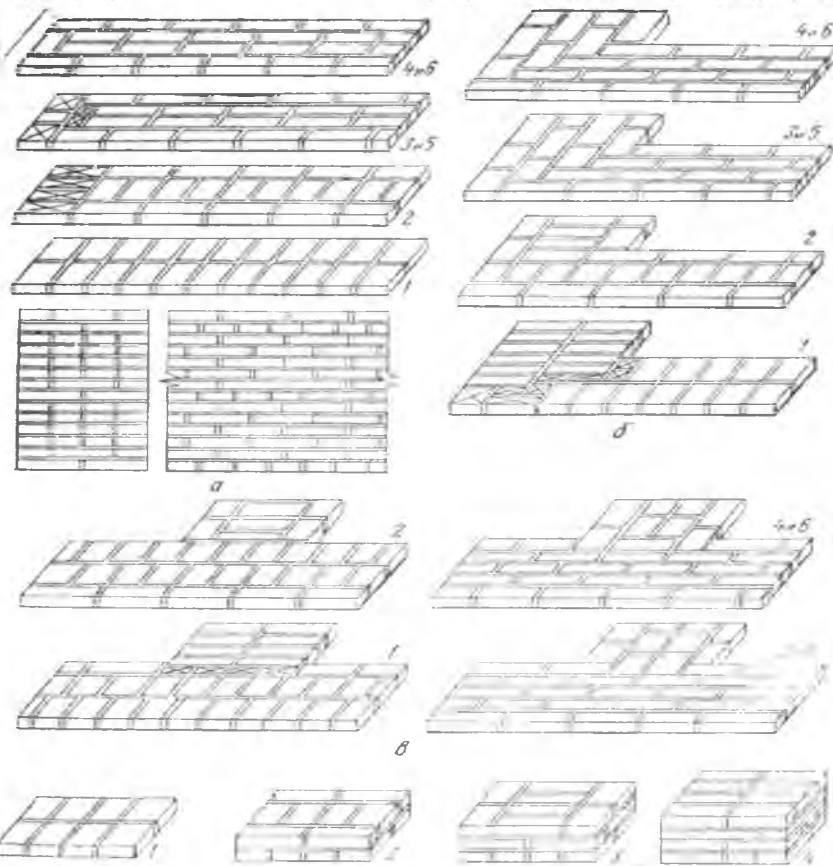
Влаштування цегляної кладки стін і стовпів
